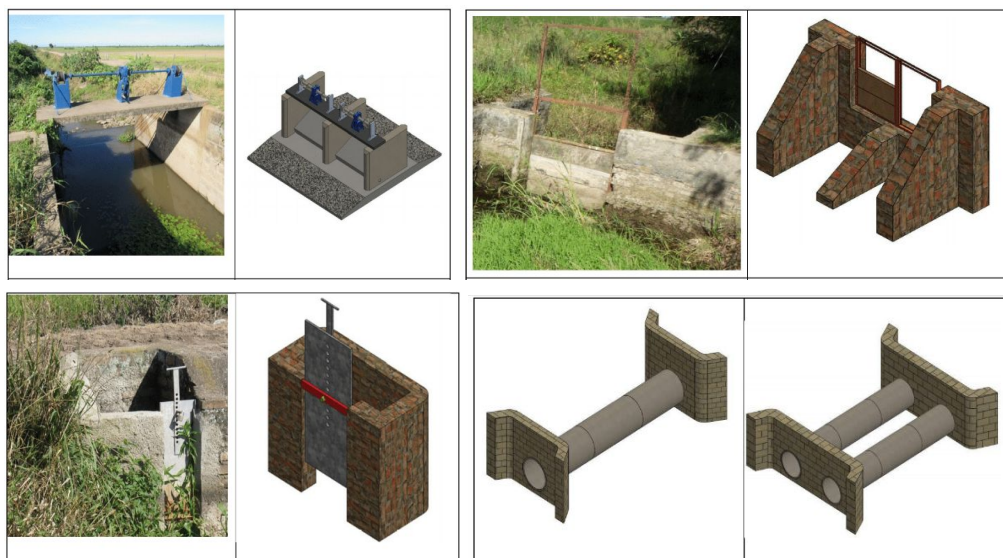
Obras de arte em fotos e modelagens 3D dos canais irrigação.
